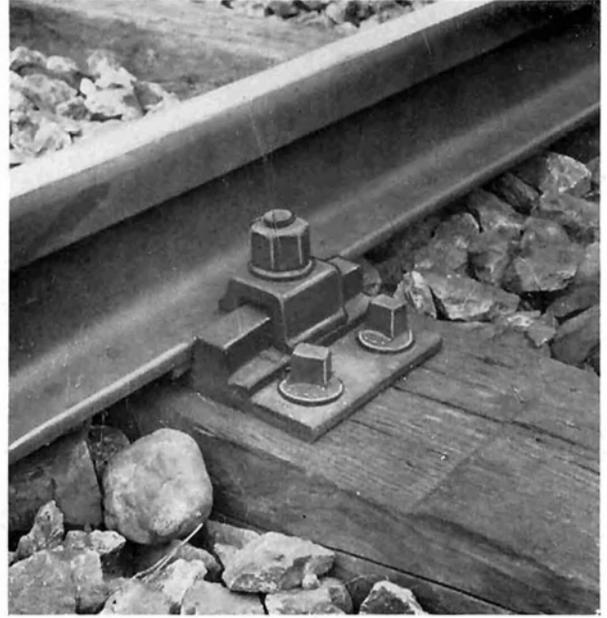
Rippenplattenbefestigung auf Holzschwellen
